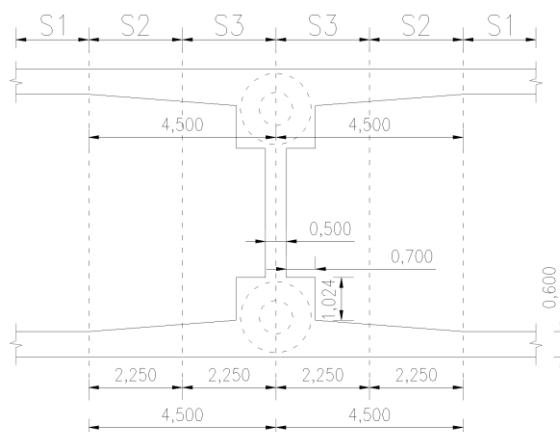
Perspetiva em planta do corte da secção transversal e denominação das secções adotadas
